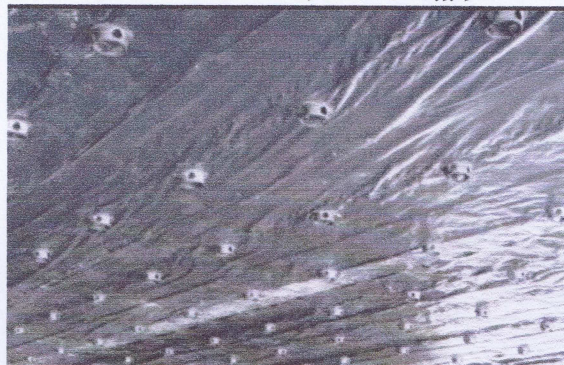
Impermeabilização com lona preta e espaçadores de concreto
